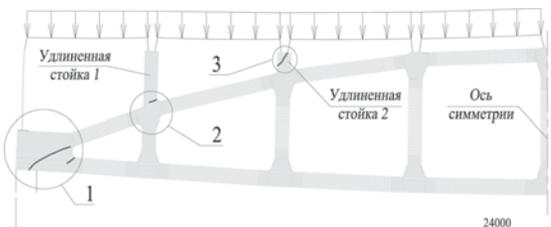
Схема железобетонной безраскосной фермы пролетом 24 м с обозначением трещин, недопустимых по местоположению и ширине раскрытия, выявленных в фермах серии 1.463.1-3/87
